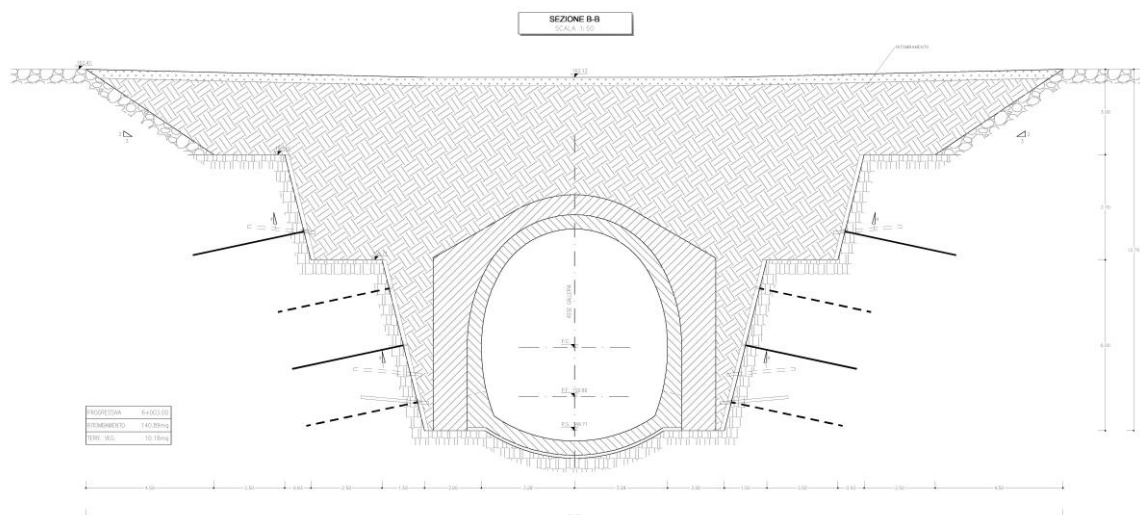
Sezione trasversale sistemazione definitiva imbocco lato Bonorva galleria Bauladu
